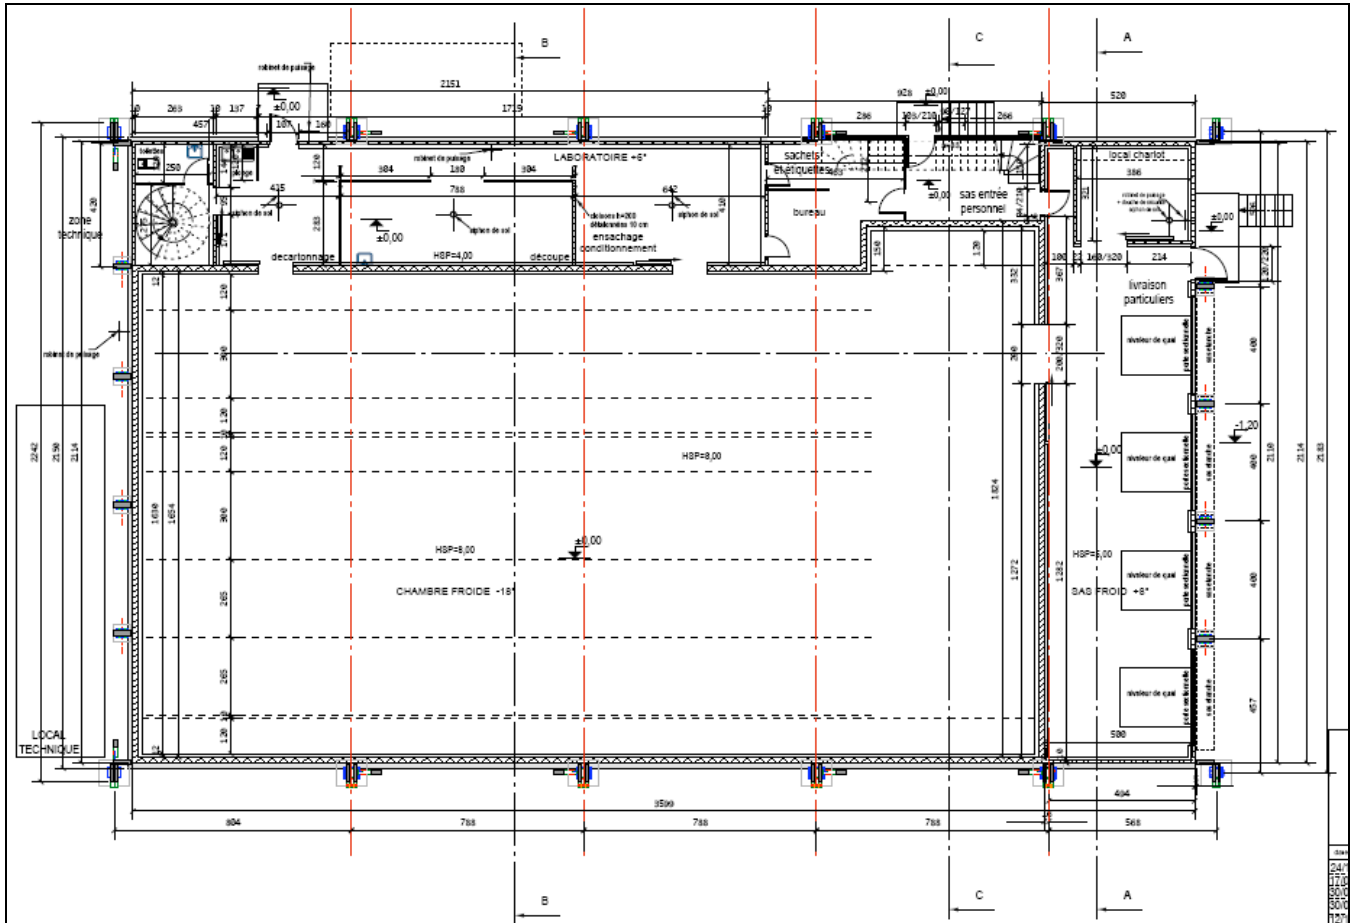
Chambre froide Hippocampe caraïbe, plan du rez-de-chaussée.
